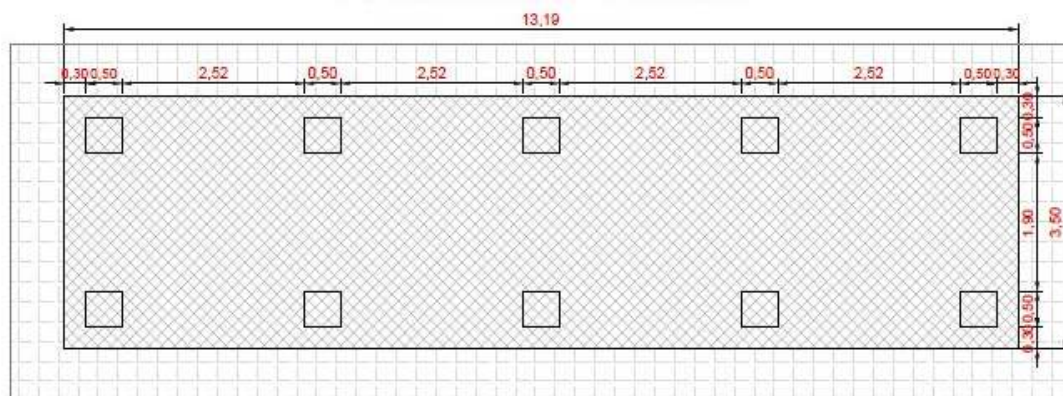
Pianta fondazioni del power station (stralcio tav. 21 "Tipico power station).
